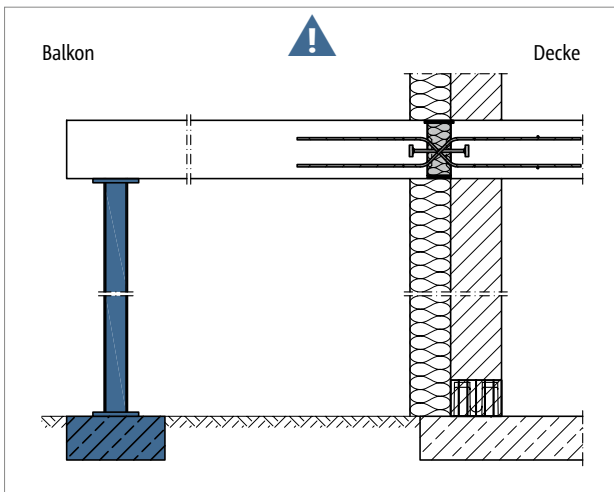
Schöck Isokorb® T Typ QP-VV: Stützung durchgängig erforderlich
